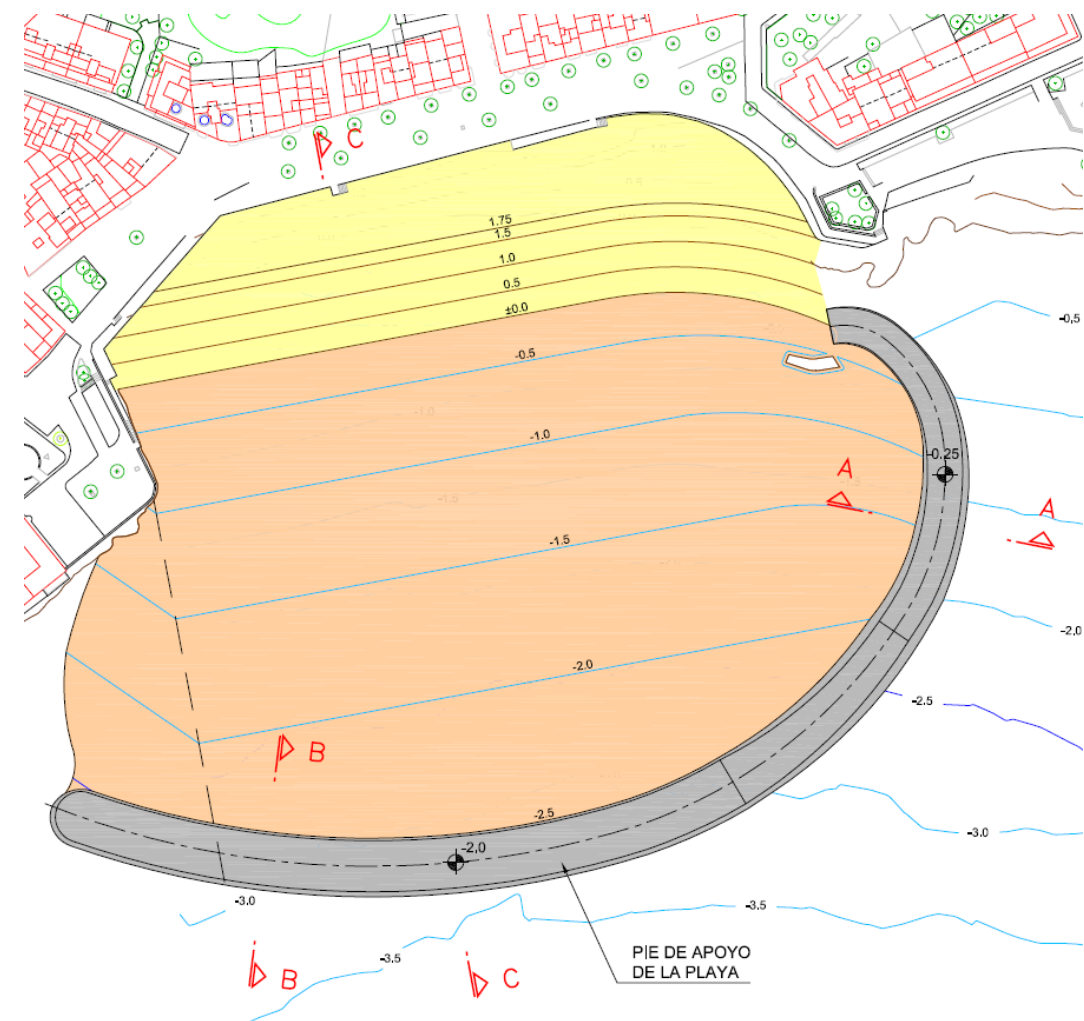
Planta de la Variante 1 de la Alternativa 2. (Fuente: Elaboración propia)
